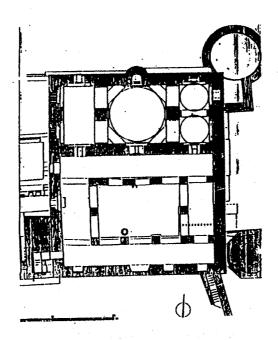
مسقط أفقي للبكيرية بصنعاء اليمن . (عن : سرجنت) .
